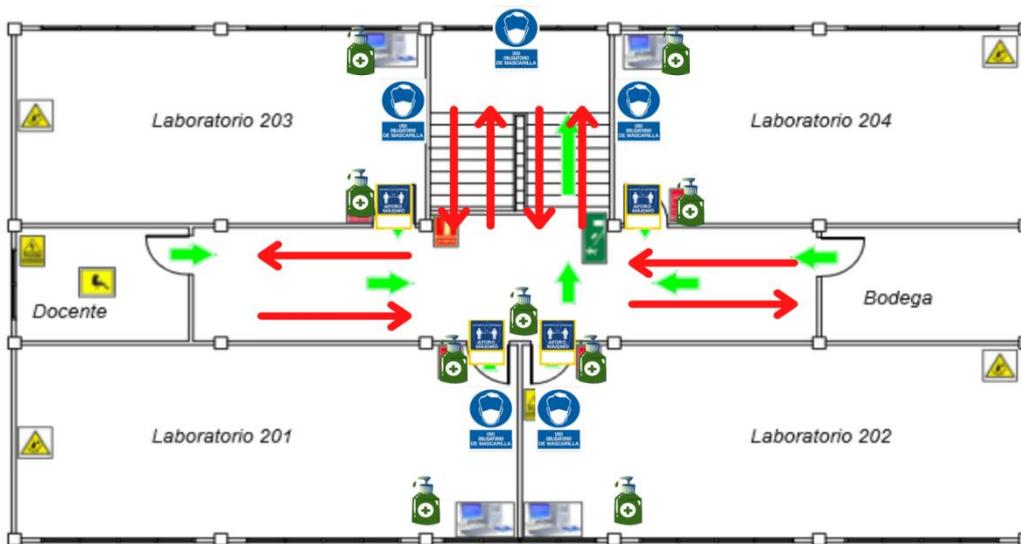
Ruta recomendada al interior del bloque P en la planta alta.
